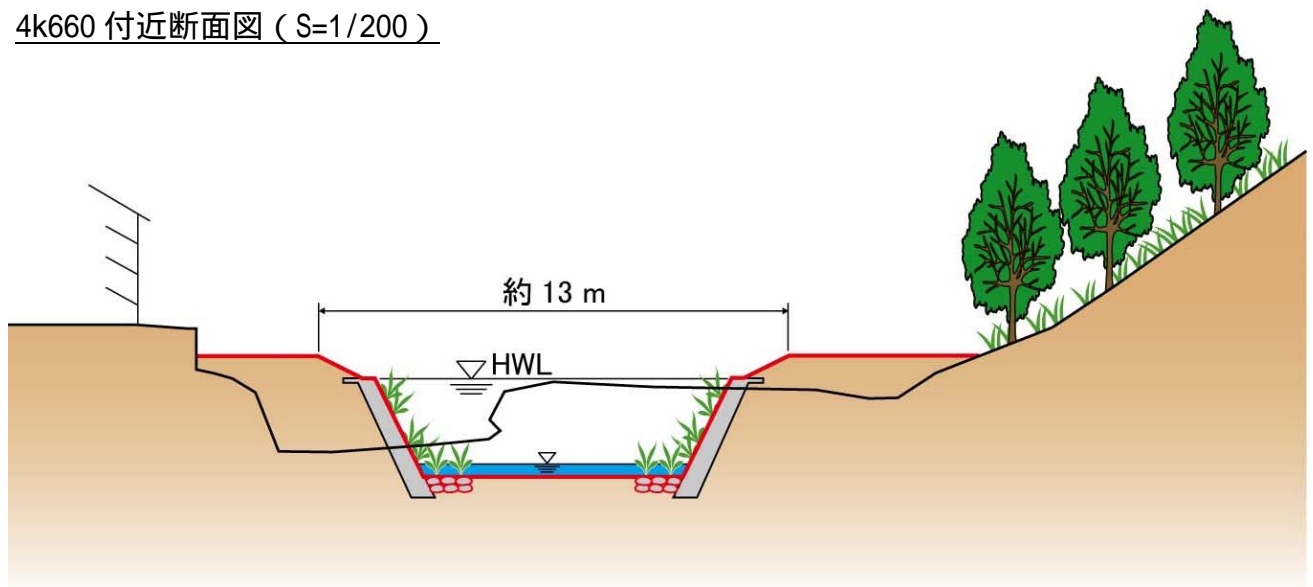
武雄川整備計画平面図 (施行の場所、代表断面図)
